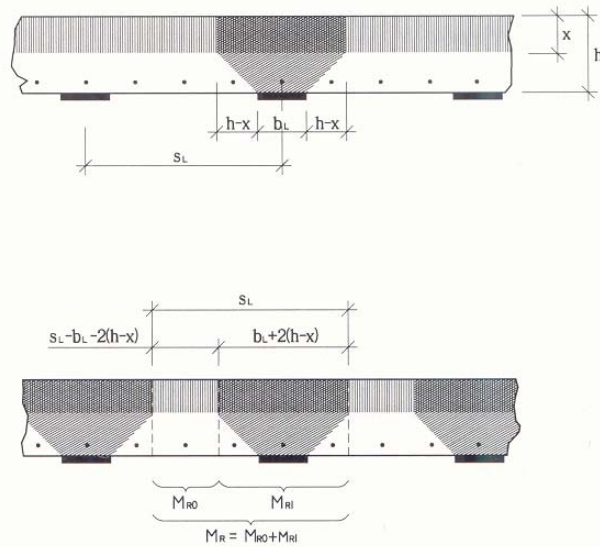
Determinación de anchos eficaces en secciones reforzadas.
